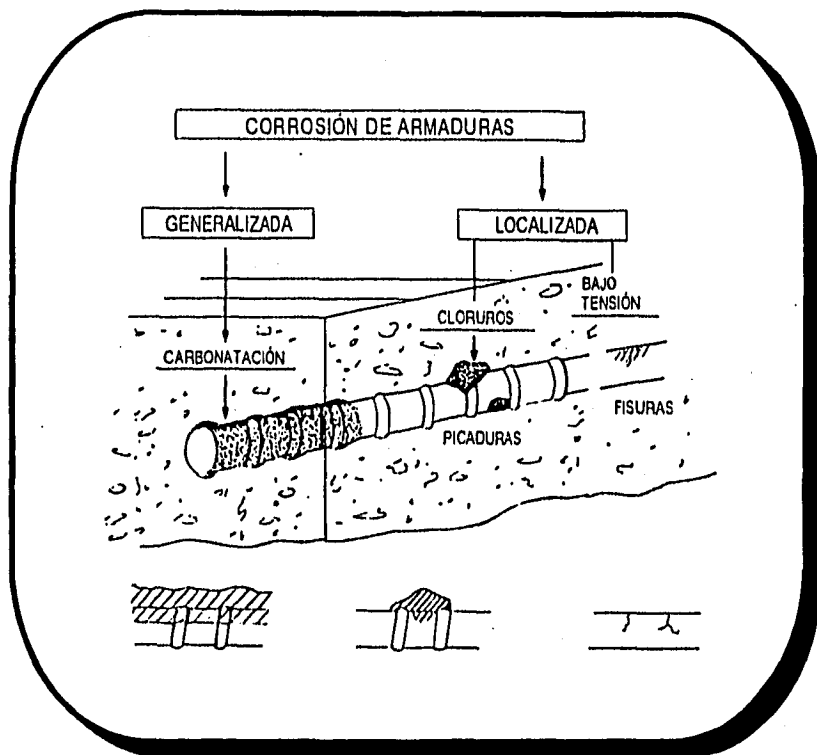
Tipos de corrosión de armaduras. Factores que las provocan.
